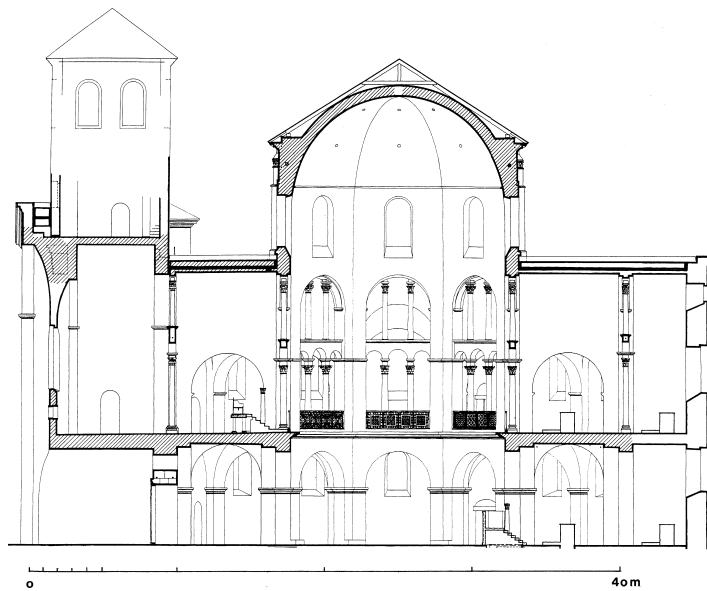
Aachen, Pfalzkapelle, Längsschnitt (Teilrekonstruktion)
